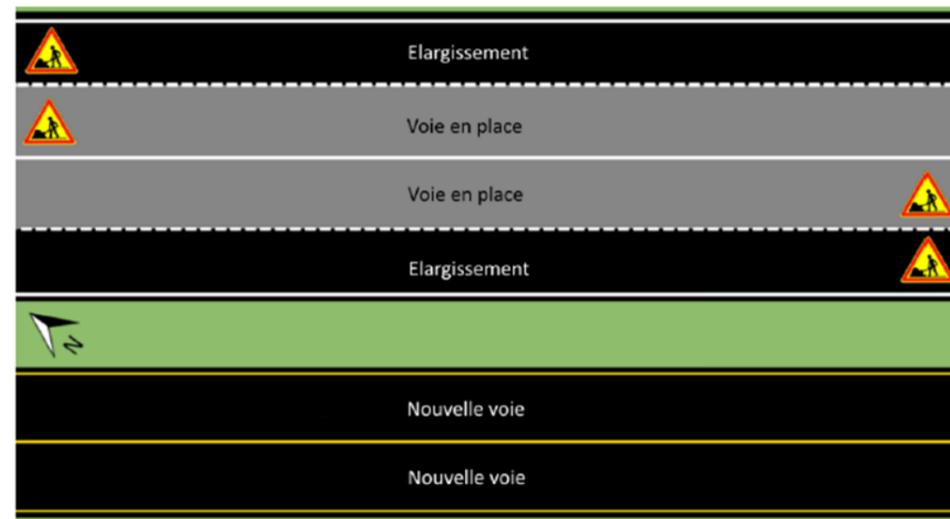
Principe d'un élargissement sur place de part et d'autre de la chaussée actuelle
